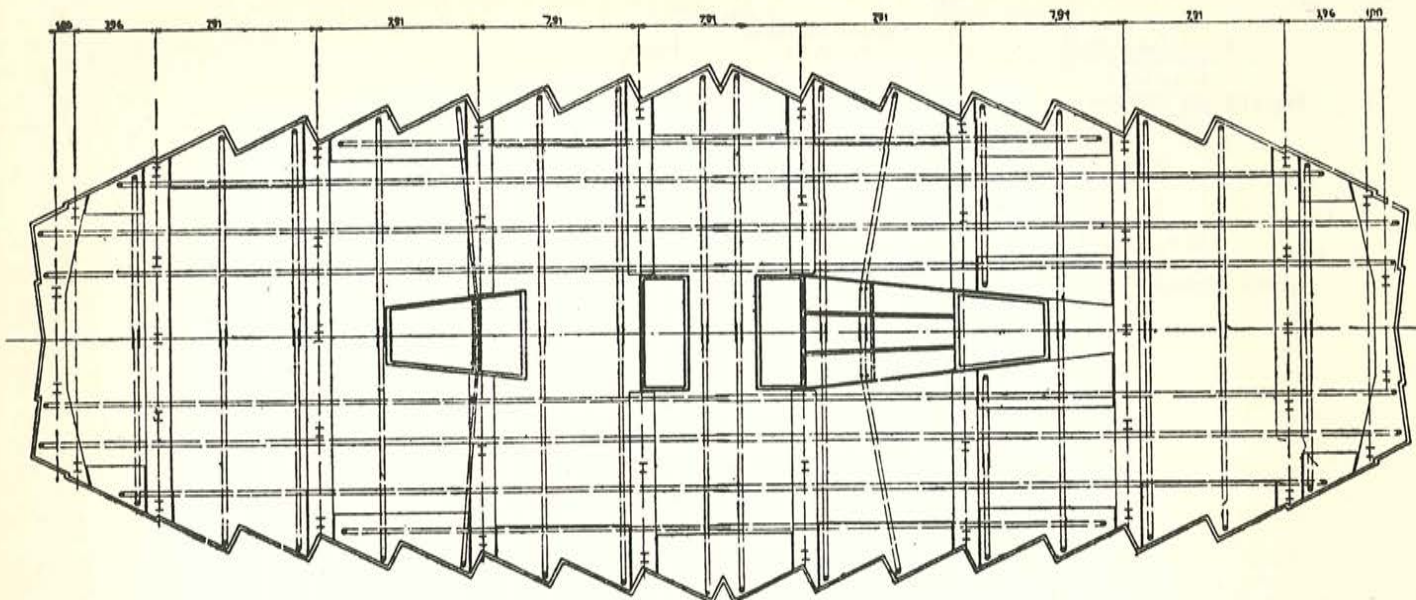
Disposición de los cables de pretensado en una planta tipo.
